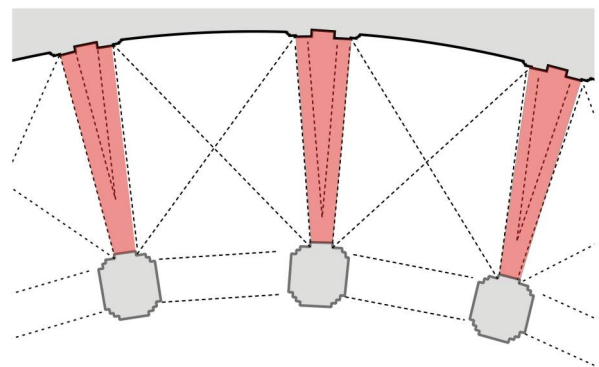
Colegio de Santo Tomás, Grundriss, Ausschnitt. Die Ausgleichsstücke zwischen den rechtwinkligen Kreuzgratgewölben sind hervorgehoben. Eigene Zeichnung, 2007.
